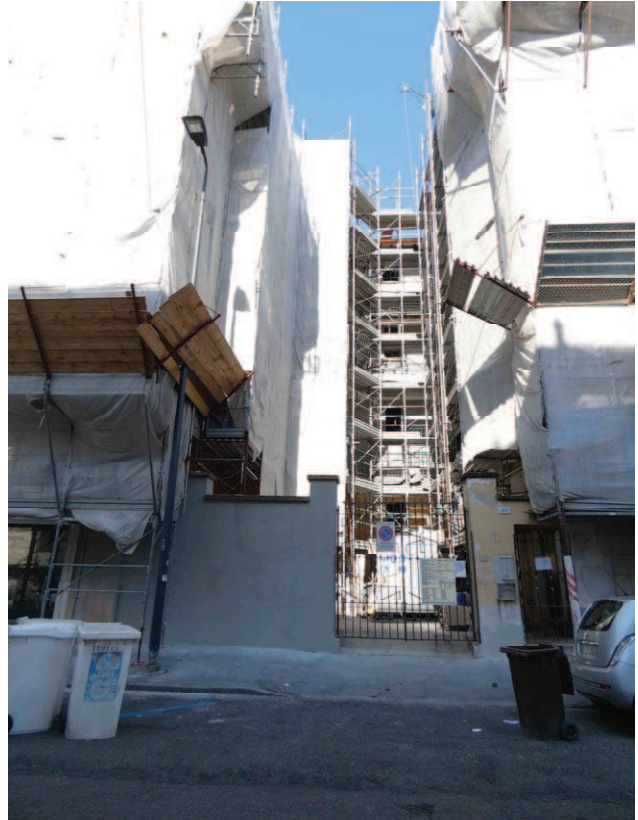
Ingresso al civico 27 di Via Luigi Manzotti
